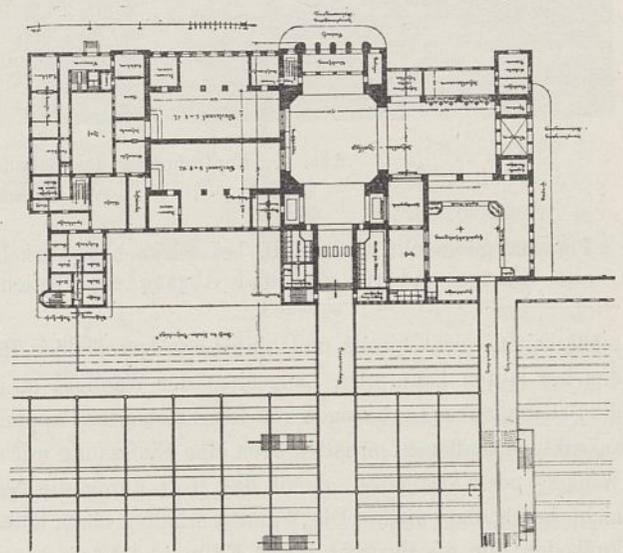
Entwurf für das Empfangsgebäude auf dem Hauptbahnhof in Darmstadt. Erdgeschöß.
